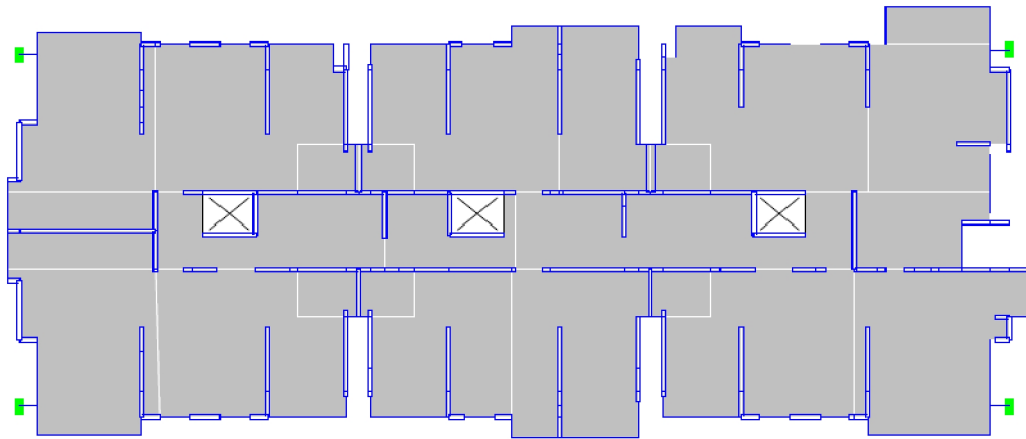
Planta cielo primer subterráneo, Edificio C.
